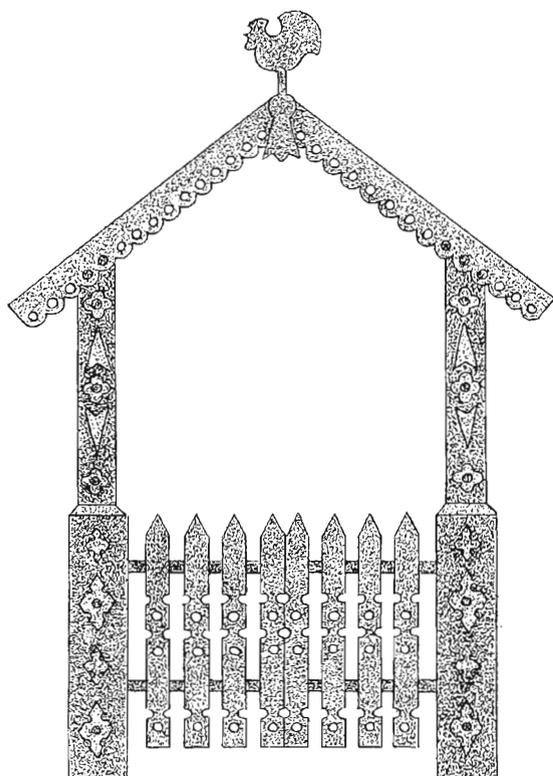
Эскиз калитки с элементами плоскопрорезной резьбы.
